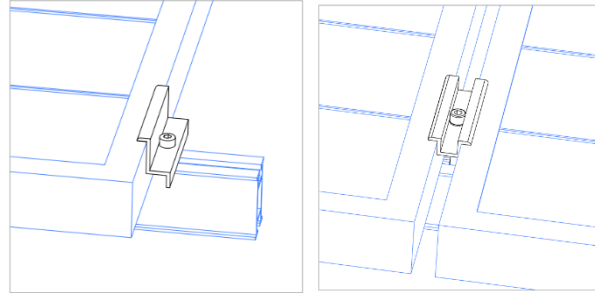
Detalle Bridas Fijación Placas Fotovoltaicas
